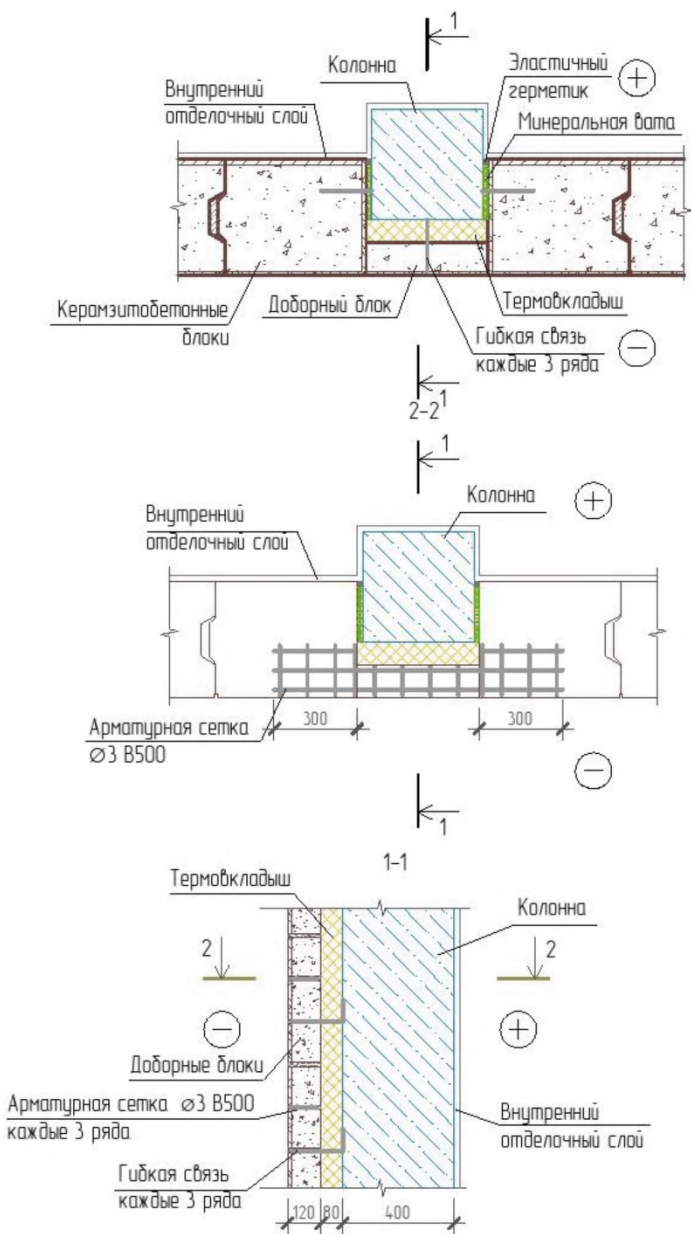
Сопряжение стены с железобетонной колонной (Вариант 1)
